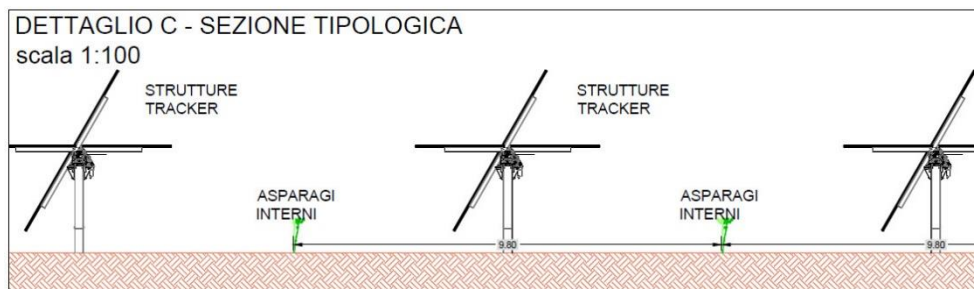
Vista planimetrica e vista in sezione della piantumazione degli asparagi tra le file dei tracker
